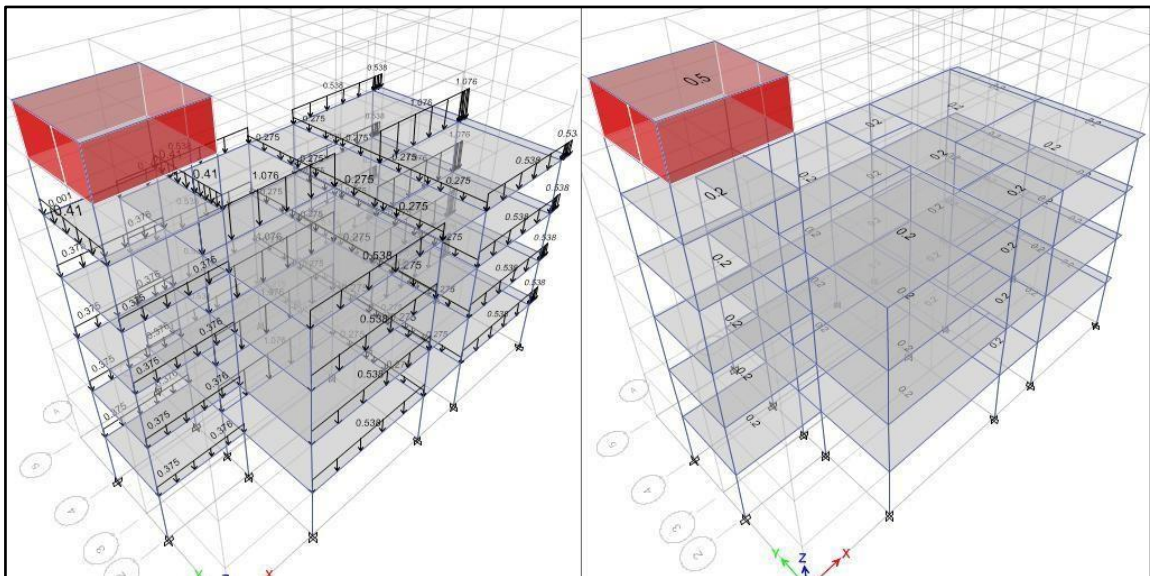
Cargas vivas aplicadas (Tn/m²)
